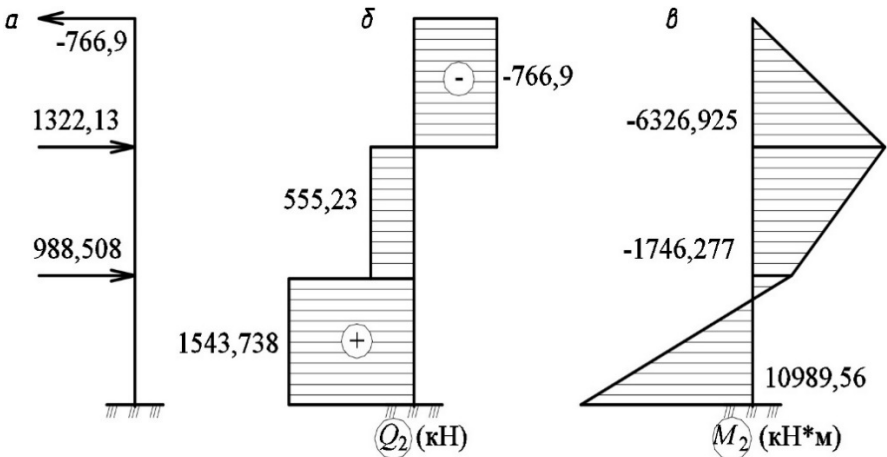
Нагрузки и эпюры внутренних усилий по второй форме колебаний: а – схема приложения нагрузки; б – эпюра поперечных сил; в – эпюра изгибающих моментов
